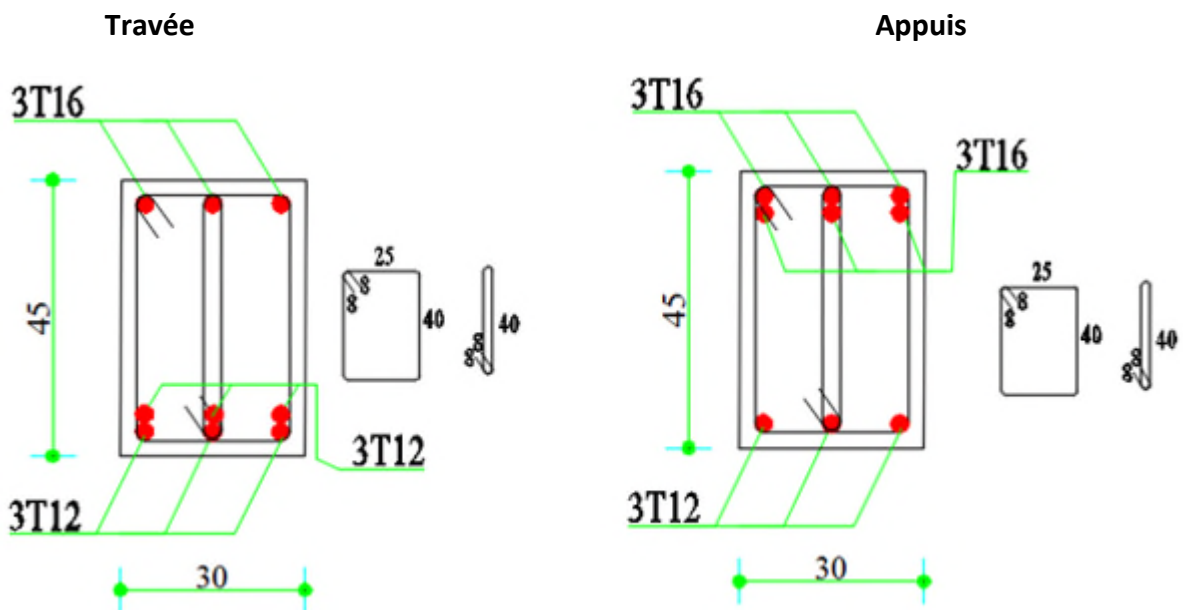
Schéma de ferrailage de la poutre principale de la terrasse
